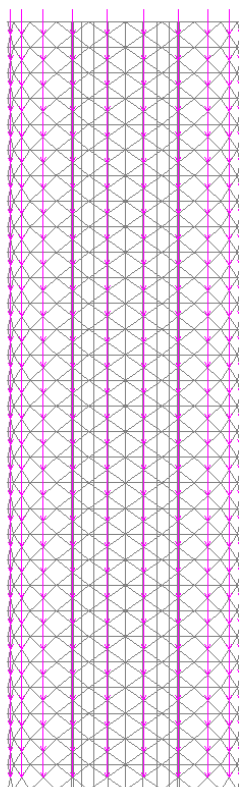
Нагрузка от веса светопрозрачных ограждающих конструкций фасада
